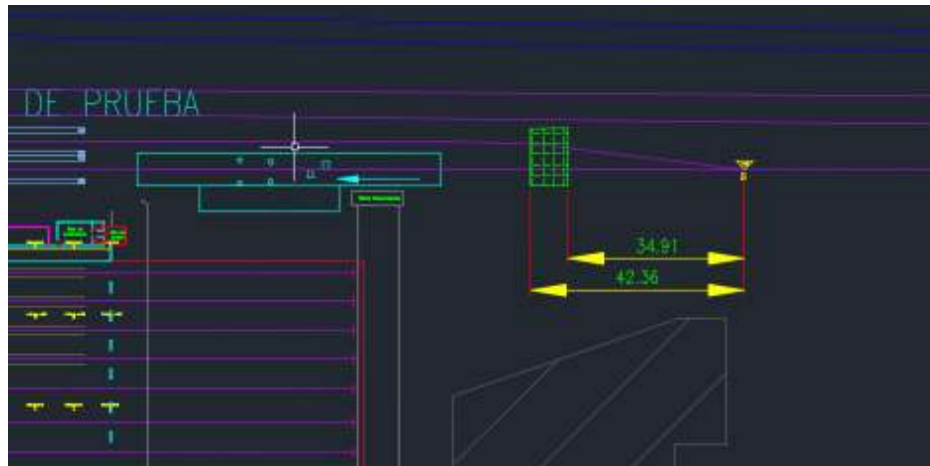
Ubicación de tramos neutros en playa de lavado en lado sur
